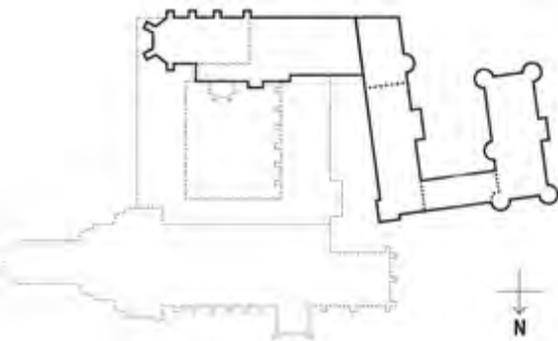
Grundriss Schlosskomplex um 1650, Darstellung Sigmar Löffler
